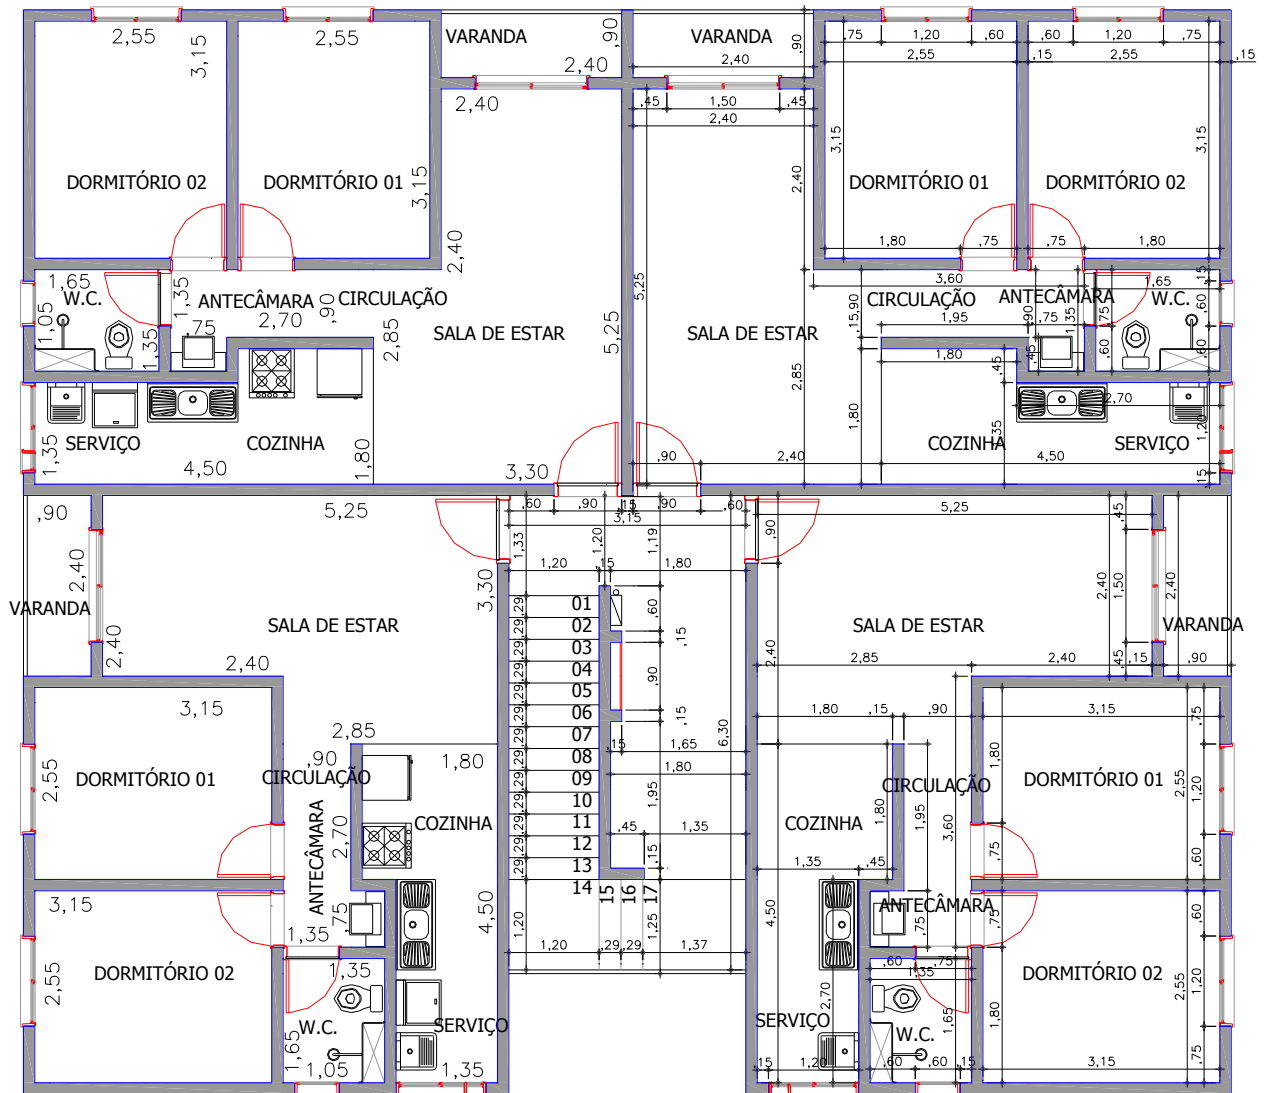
Edifício Vitória Jundiá: planta arquitetônica do pavimento tipo
